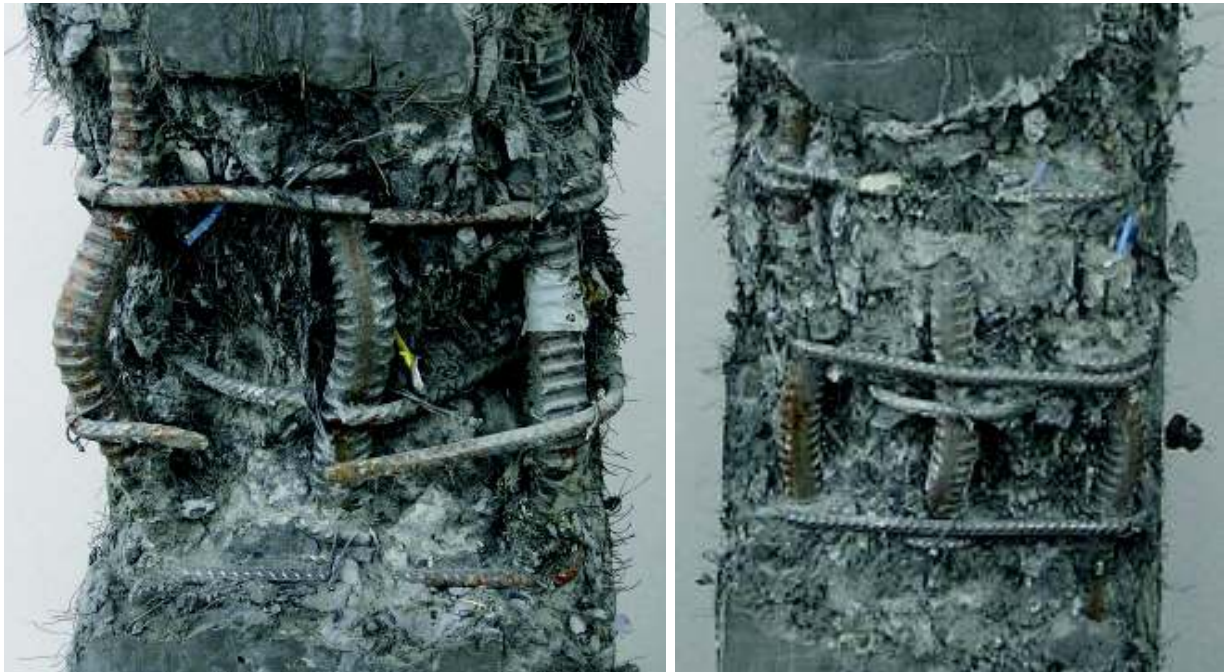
UHPFRC-Stützen SE1 (links) und SE2 (rechts): Detail der Bruchzone mit abgeplatzttem Beton, ausgeknickter Längsbewehrung und gebrochenen Bügeln
